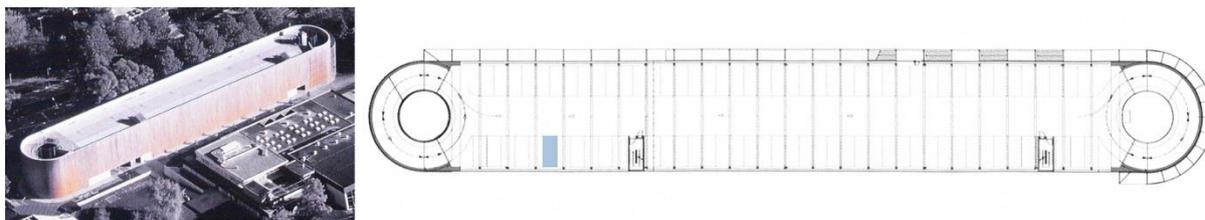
Beispielhafter Grundriss eines Parkhauses | Parkhaus am Bollwerksturm | MGF Architekten GmbH | Heilbronn (D) | 1998
